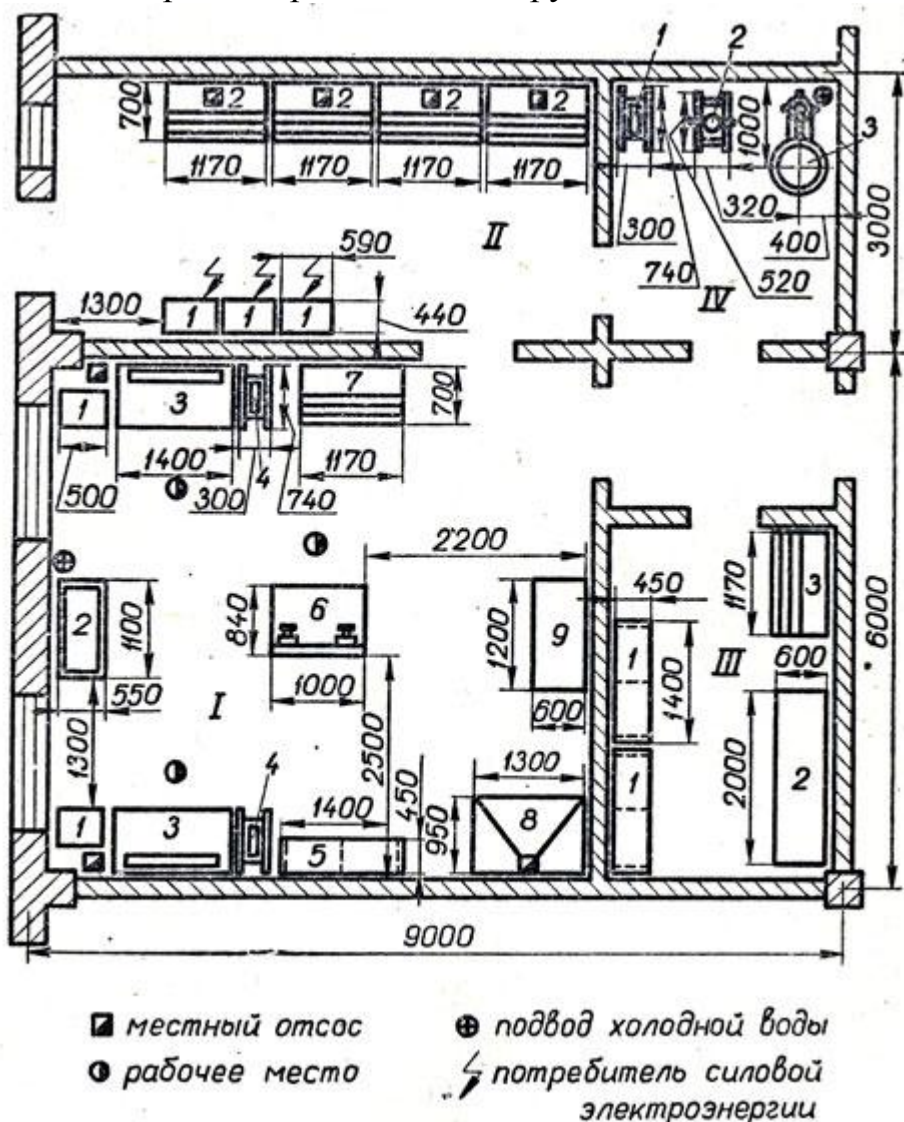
Планировка аккумуляторного цеха: I - ремонтное отделение: 1 - лари для отходов; 2 - кислотоупорная ванна для промывки деталей; 3 - верстаки для ремонта батарей; 4 - ванны для слива электролита; 5 - стеллаж для деталей; 6 - стенд для проверки и разряда аккумуляторных батарей; 7 - стеллаж для батарей; 8 - верстак с оборудованием для плавки свинца и мастики (с вытяжным устройством); 9 - шкаф для материалов; II - зарядная: 1 - выпрямители; 2 - стеллажи для заряда батареи; III - отделение приема: 1 - стеллажи для деталей; 2 - стеллаж для бутылей; 3 - стеллаж для батарей; IV - кислотная: 1 - ванна для приготовления электролита; 2 - приспособление для разлива кислоты; 3 - электрический дистиллятор
